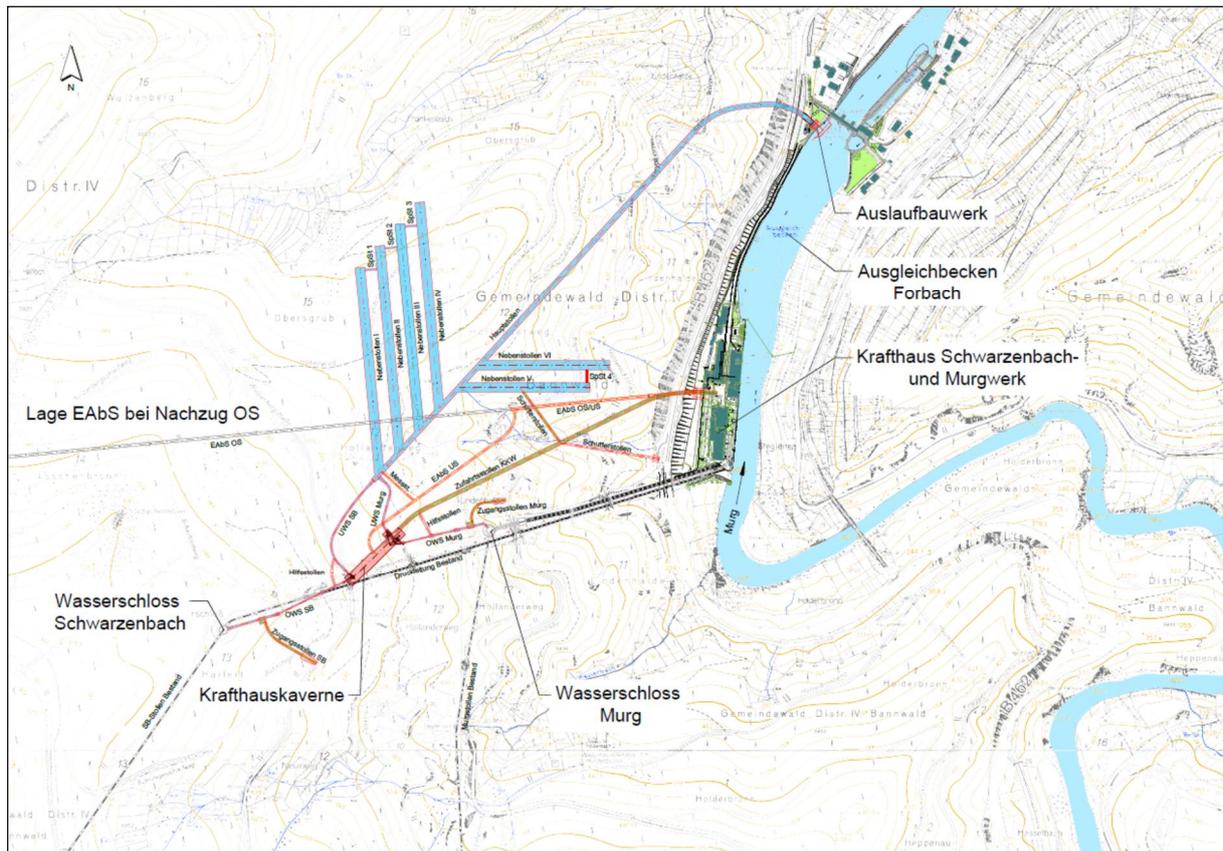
Übersichtslageplan Schwarzenbach- und Murgwerk (Auszug aus Plan B.IV.3)
